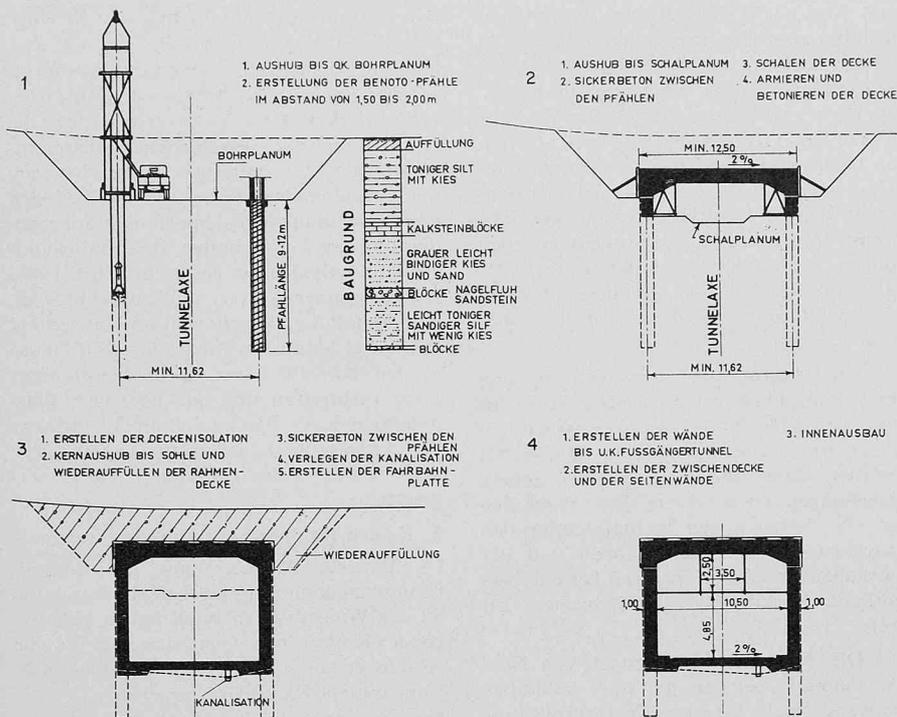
Ulmbergtunnel Zürich: Ausführung der Pfahlwand System Benoto
